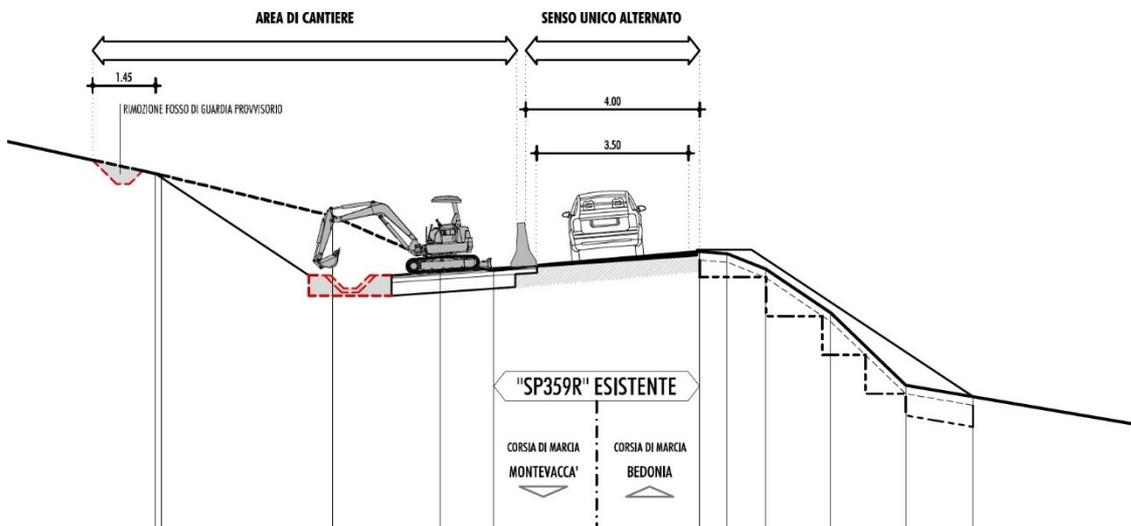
TRATTO 3, FASE 3: TRAFFICO SU CORSIA DI MONTE (ESTRATTO DALL'ELAB. PD.04.04)
